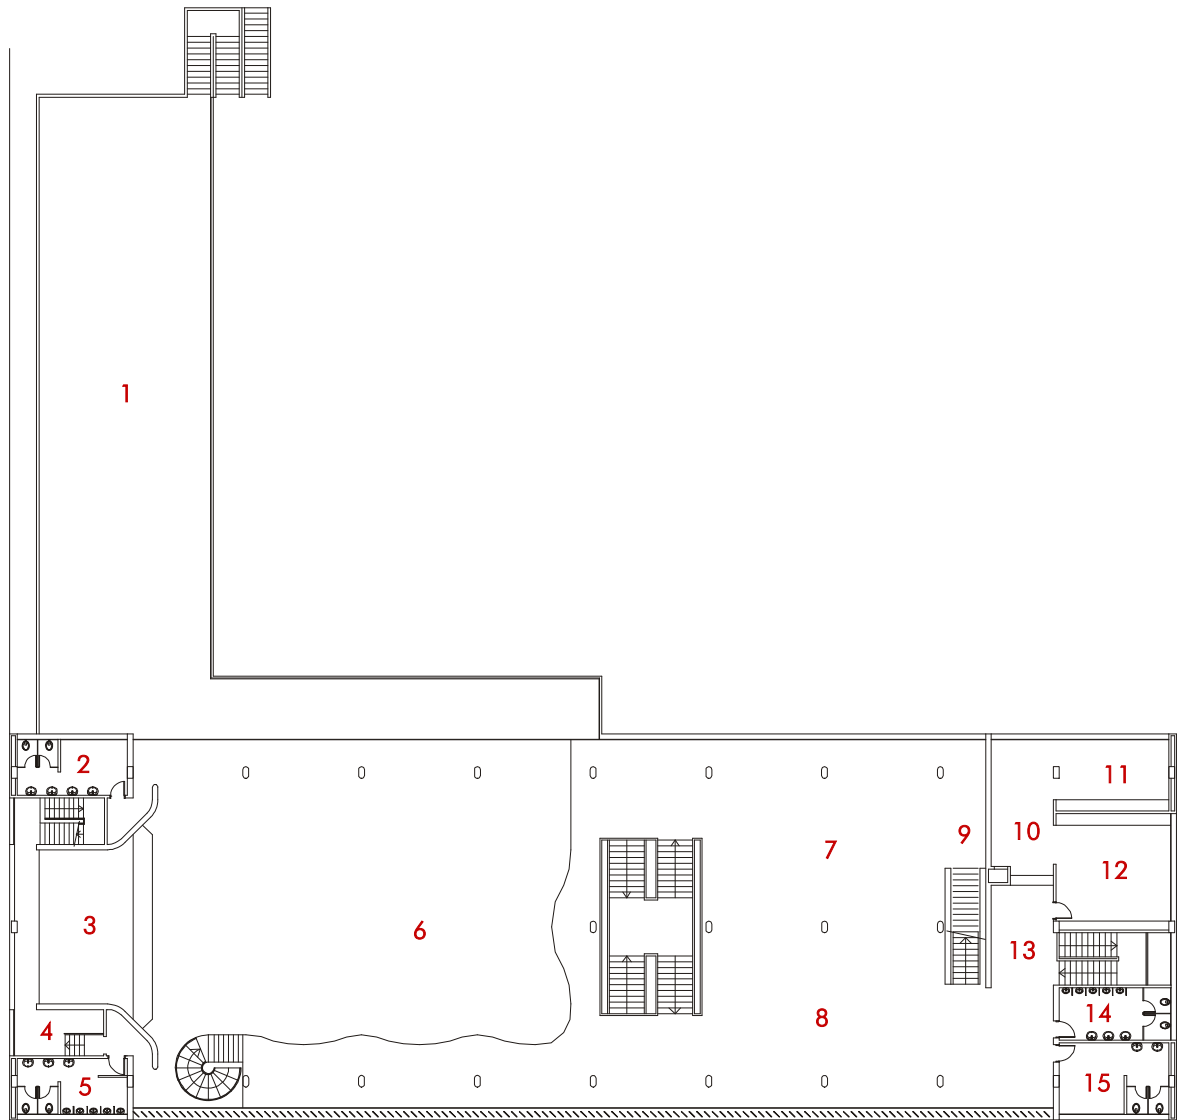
Planta do primeiro pavimento: terraço Edifício dos Vestiários e Sede
